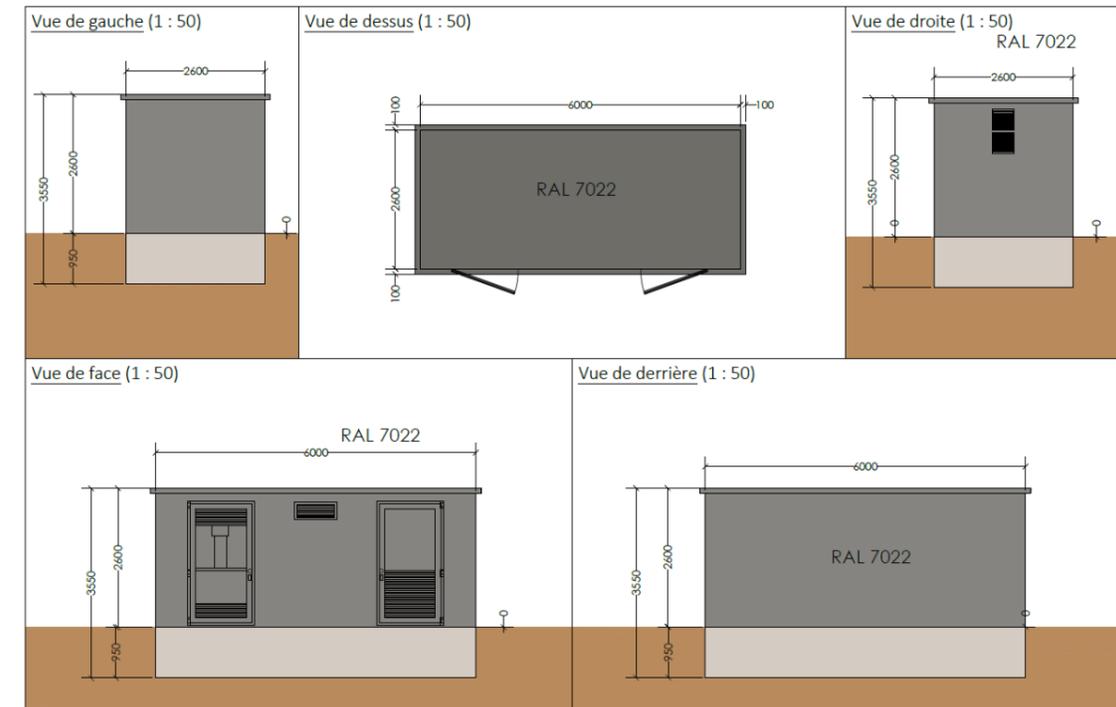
Plan de coupe et façades d'un poste de transformation
